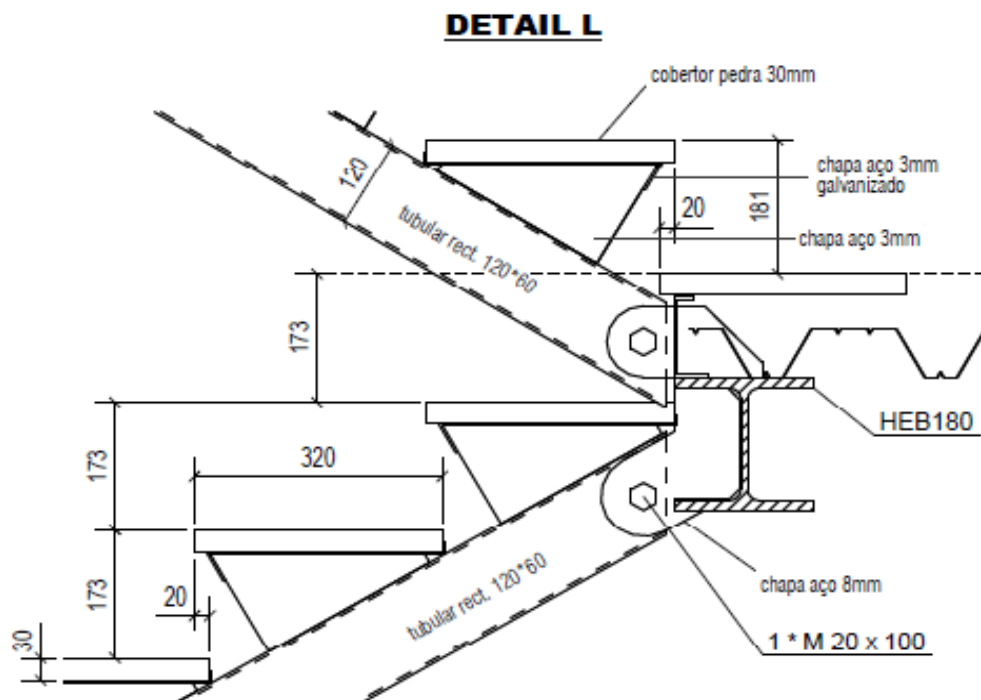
Pormenor construtivo da escada assinalado na Figura 3.1 (Subsecção 3.1.1) com um círculo (DET L)
